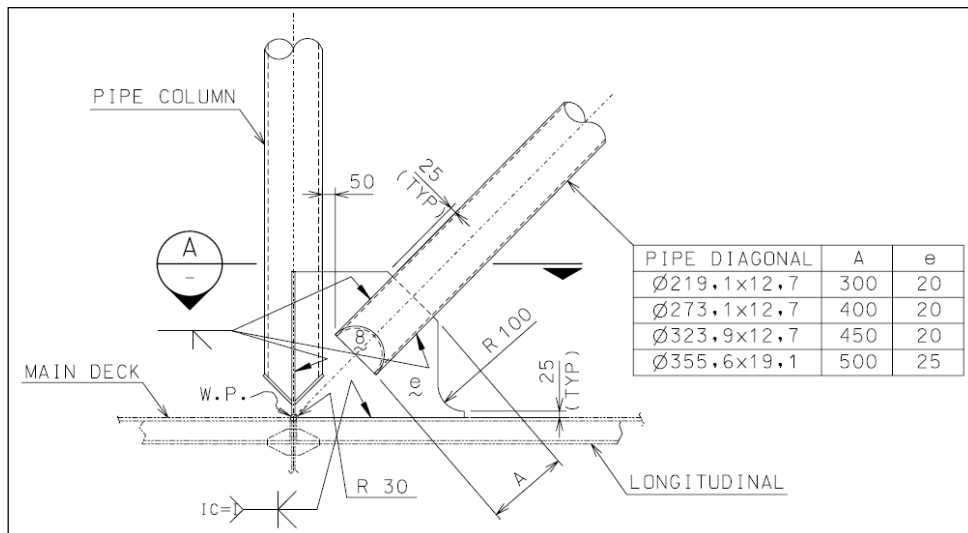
Suporte do módulo – conexões tipos 3 e 4 – vista longitudinal.
